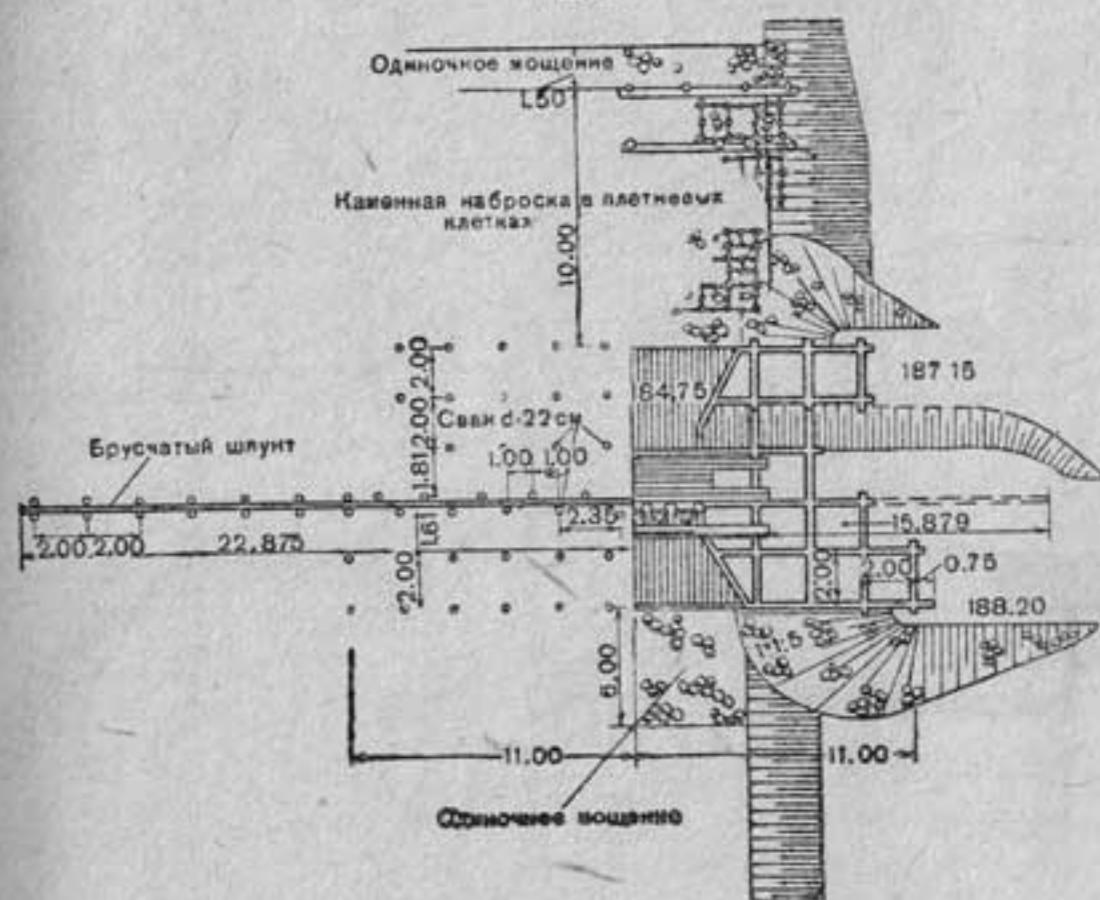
Плотина № 3 (вид с верхнего бьефа и план).
